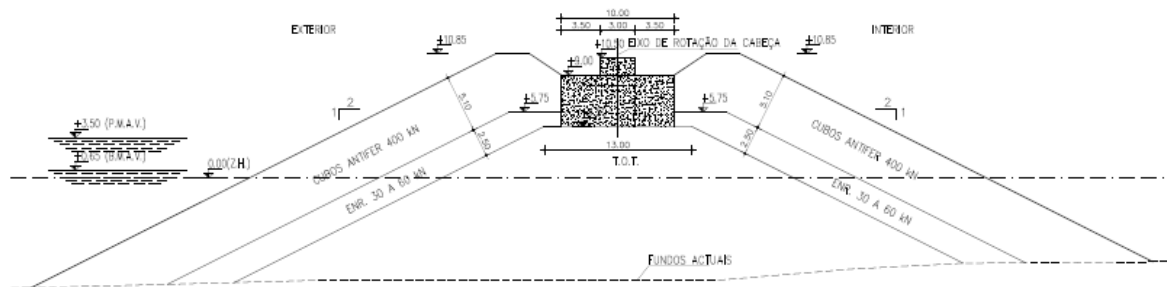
Perfil transversal e de rotação na zona da cabeça
